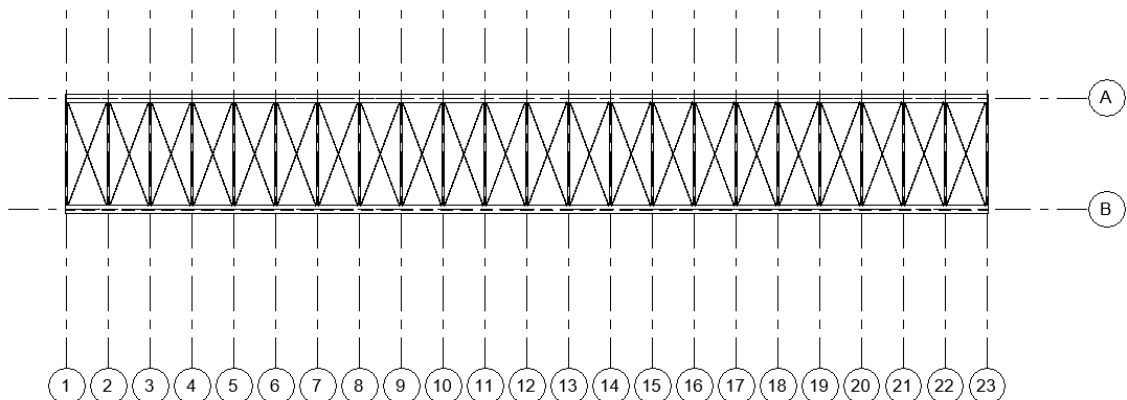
Vista de planta de vigas longitudinales, viguetas y tornapuntas.
